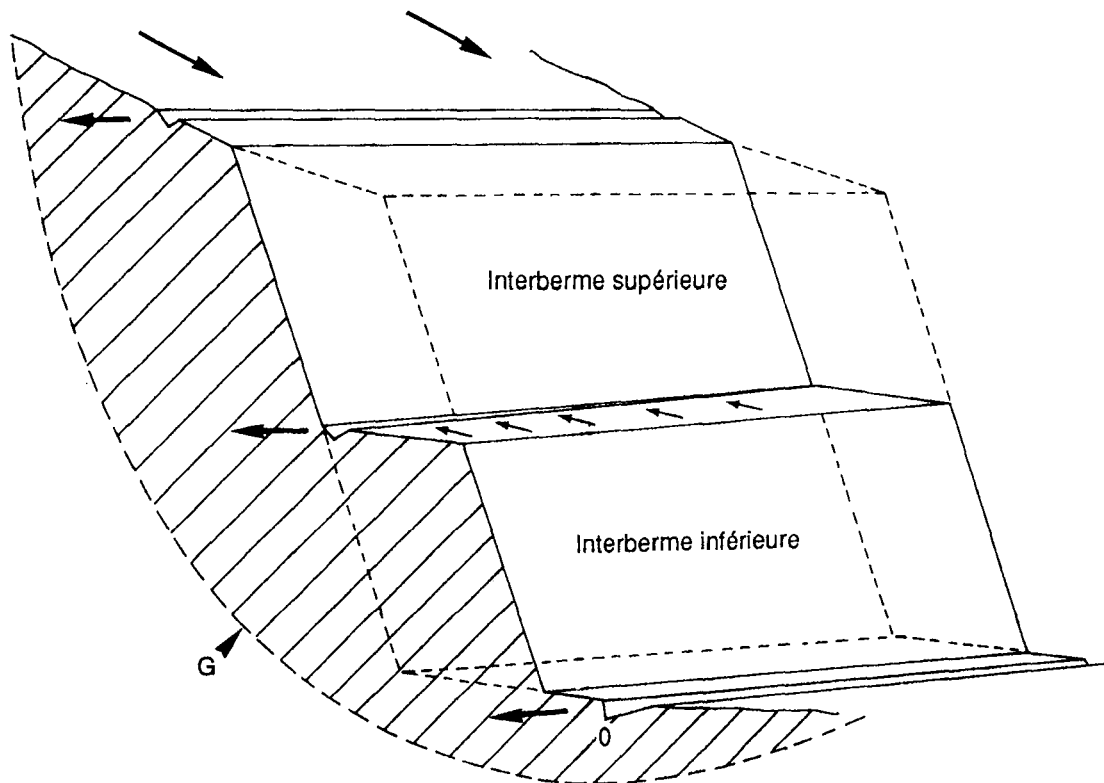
Schéma d'une risberme. La risberme contrecarre la rupture potentielle G (glissement profond).
